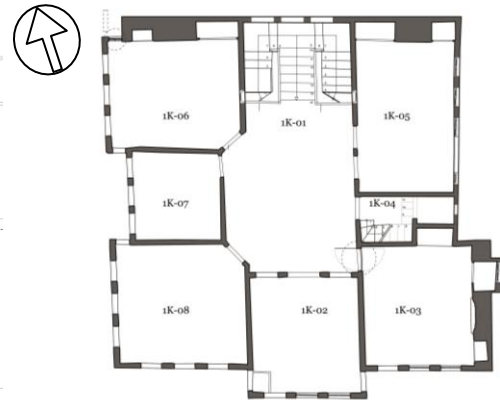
Aykaç Konağı Vaziyet Planı [265, 271]
